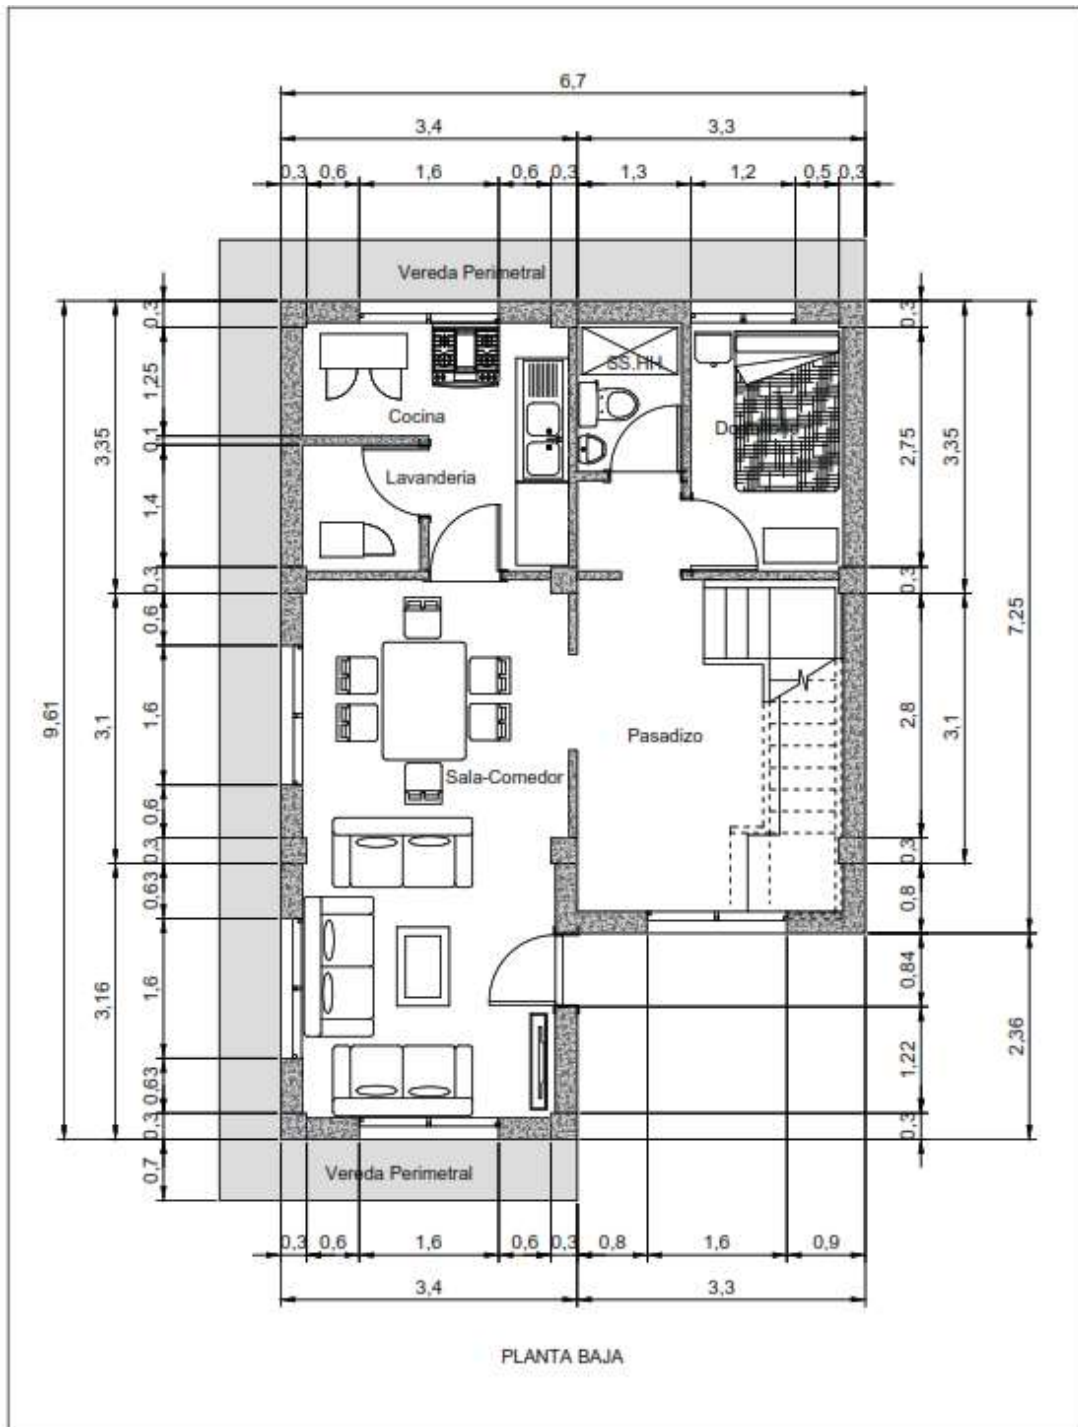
Planta de Arquitectura primer nivel de 56,57 m² (sistema constructivo tradicional).
